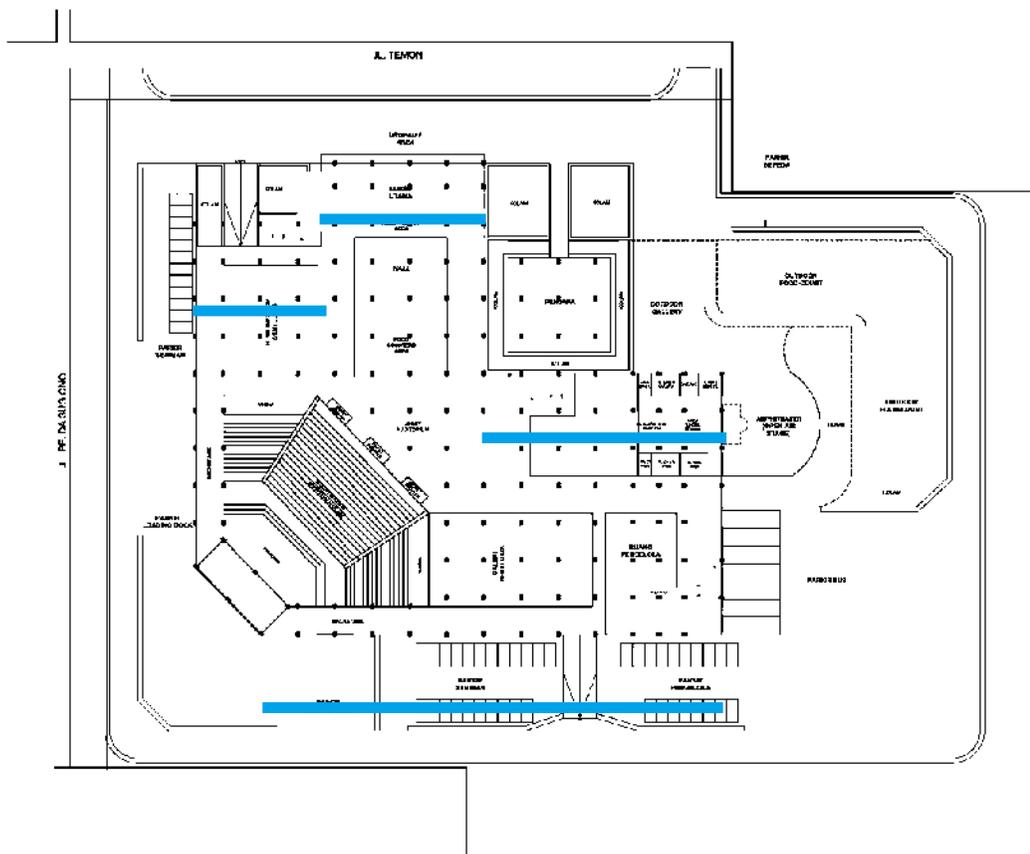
Sketsa Konsep Potongan Curtain Wall
